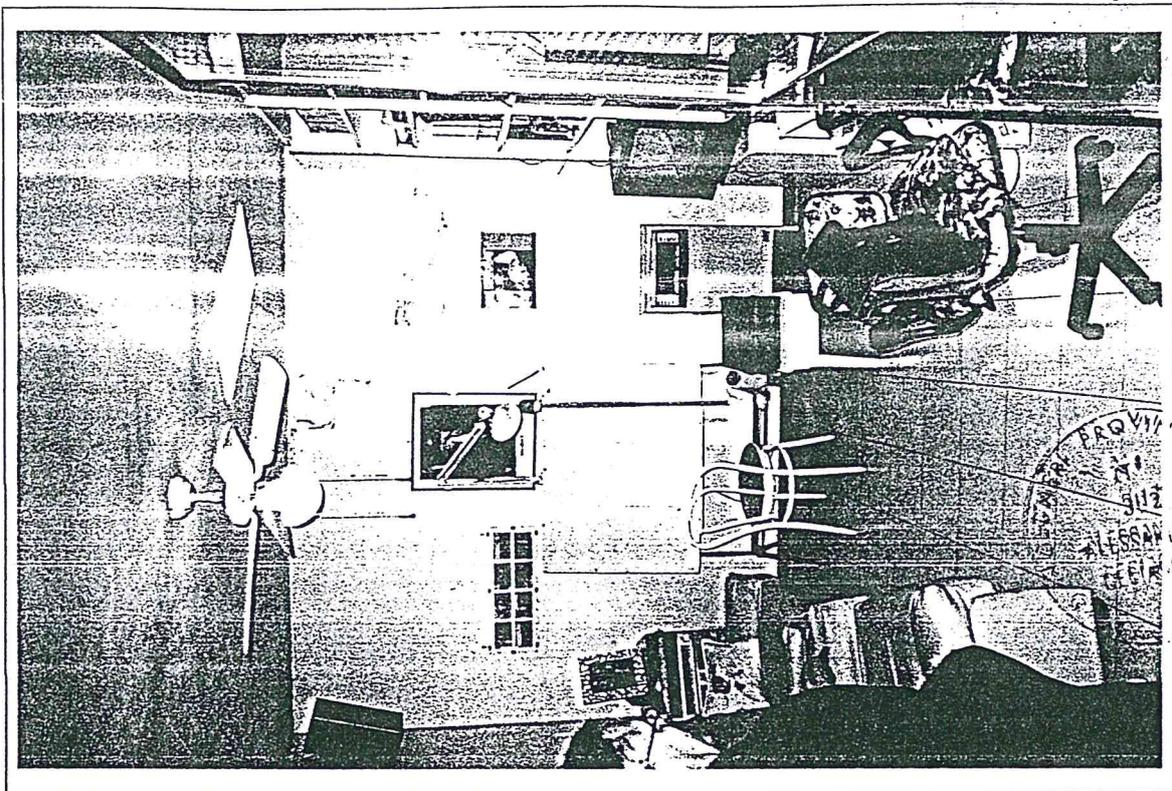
Sottotetto proprietà Paolini, civico 23
